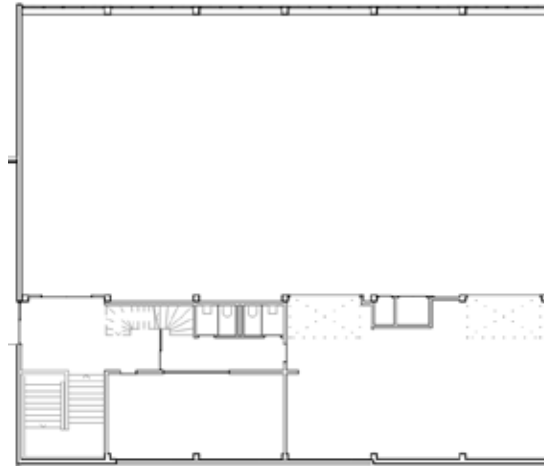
Grundriss Turnhallentrakt zur Illustration der Wirkungsrichtung des Erdbebens.
